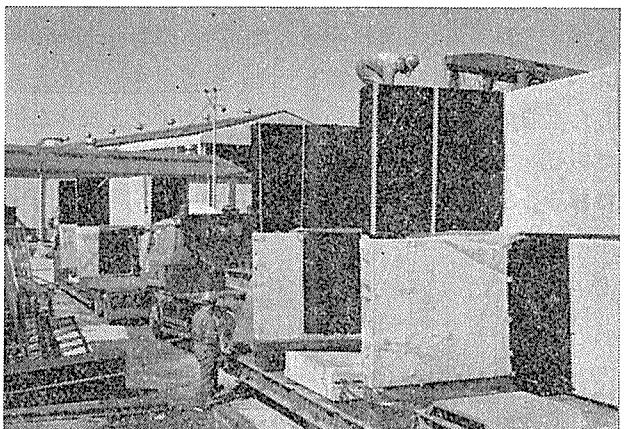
キ字形プレキャスト部材がトレーラー トラックで工場から出荷される状況
